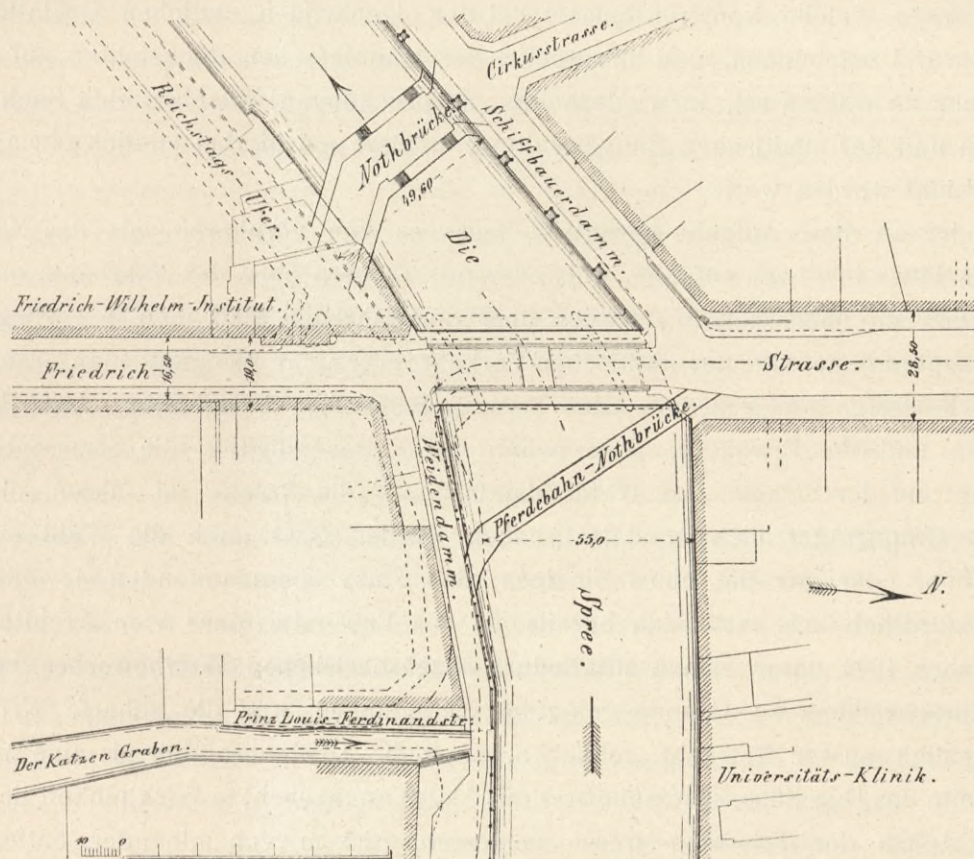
Lageplan der alten Weidendammer Brücke und der Hilfs-Brücken.
